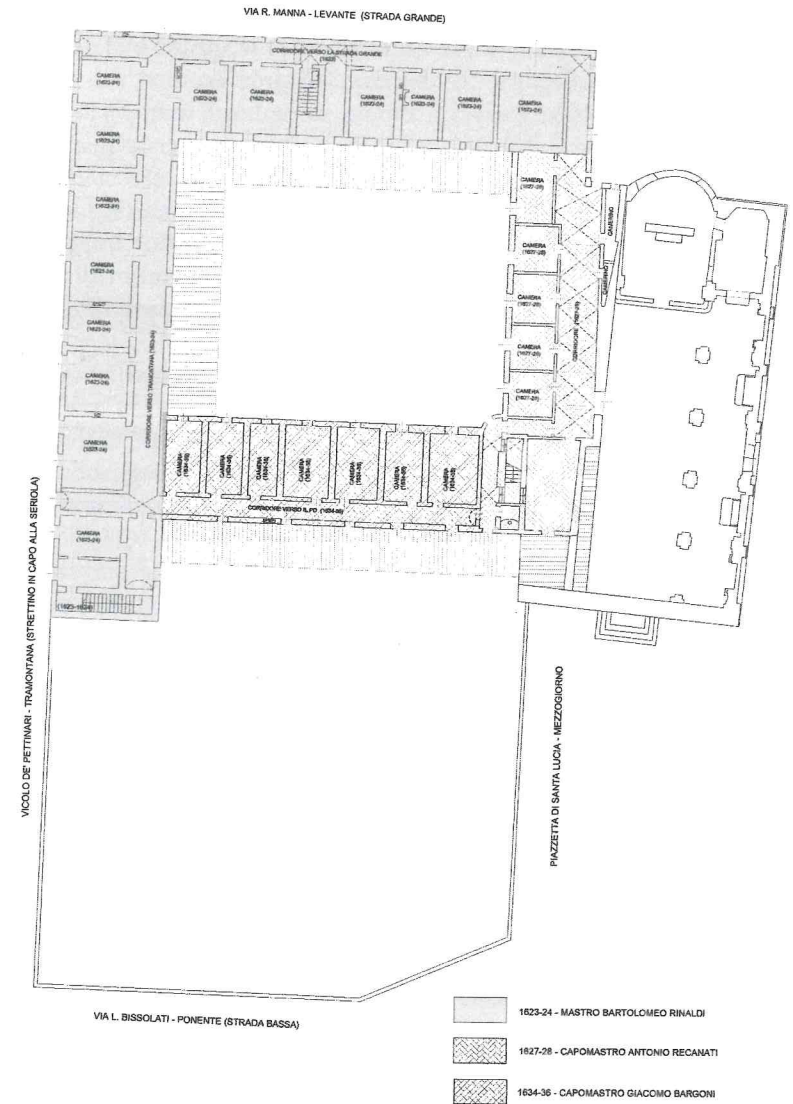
Ipotesi di ricostruzione del piano secondo nel 1650, con individuazione delle fasi costruttive.
